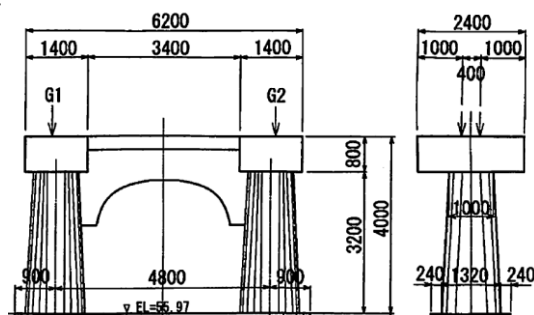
2主鈑桁 P₈ 橋脚概要 (単位: mm)
